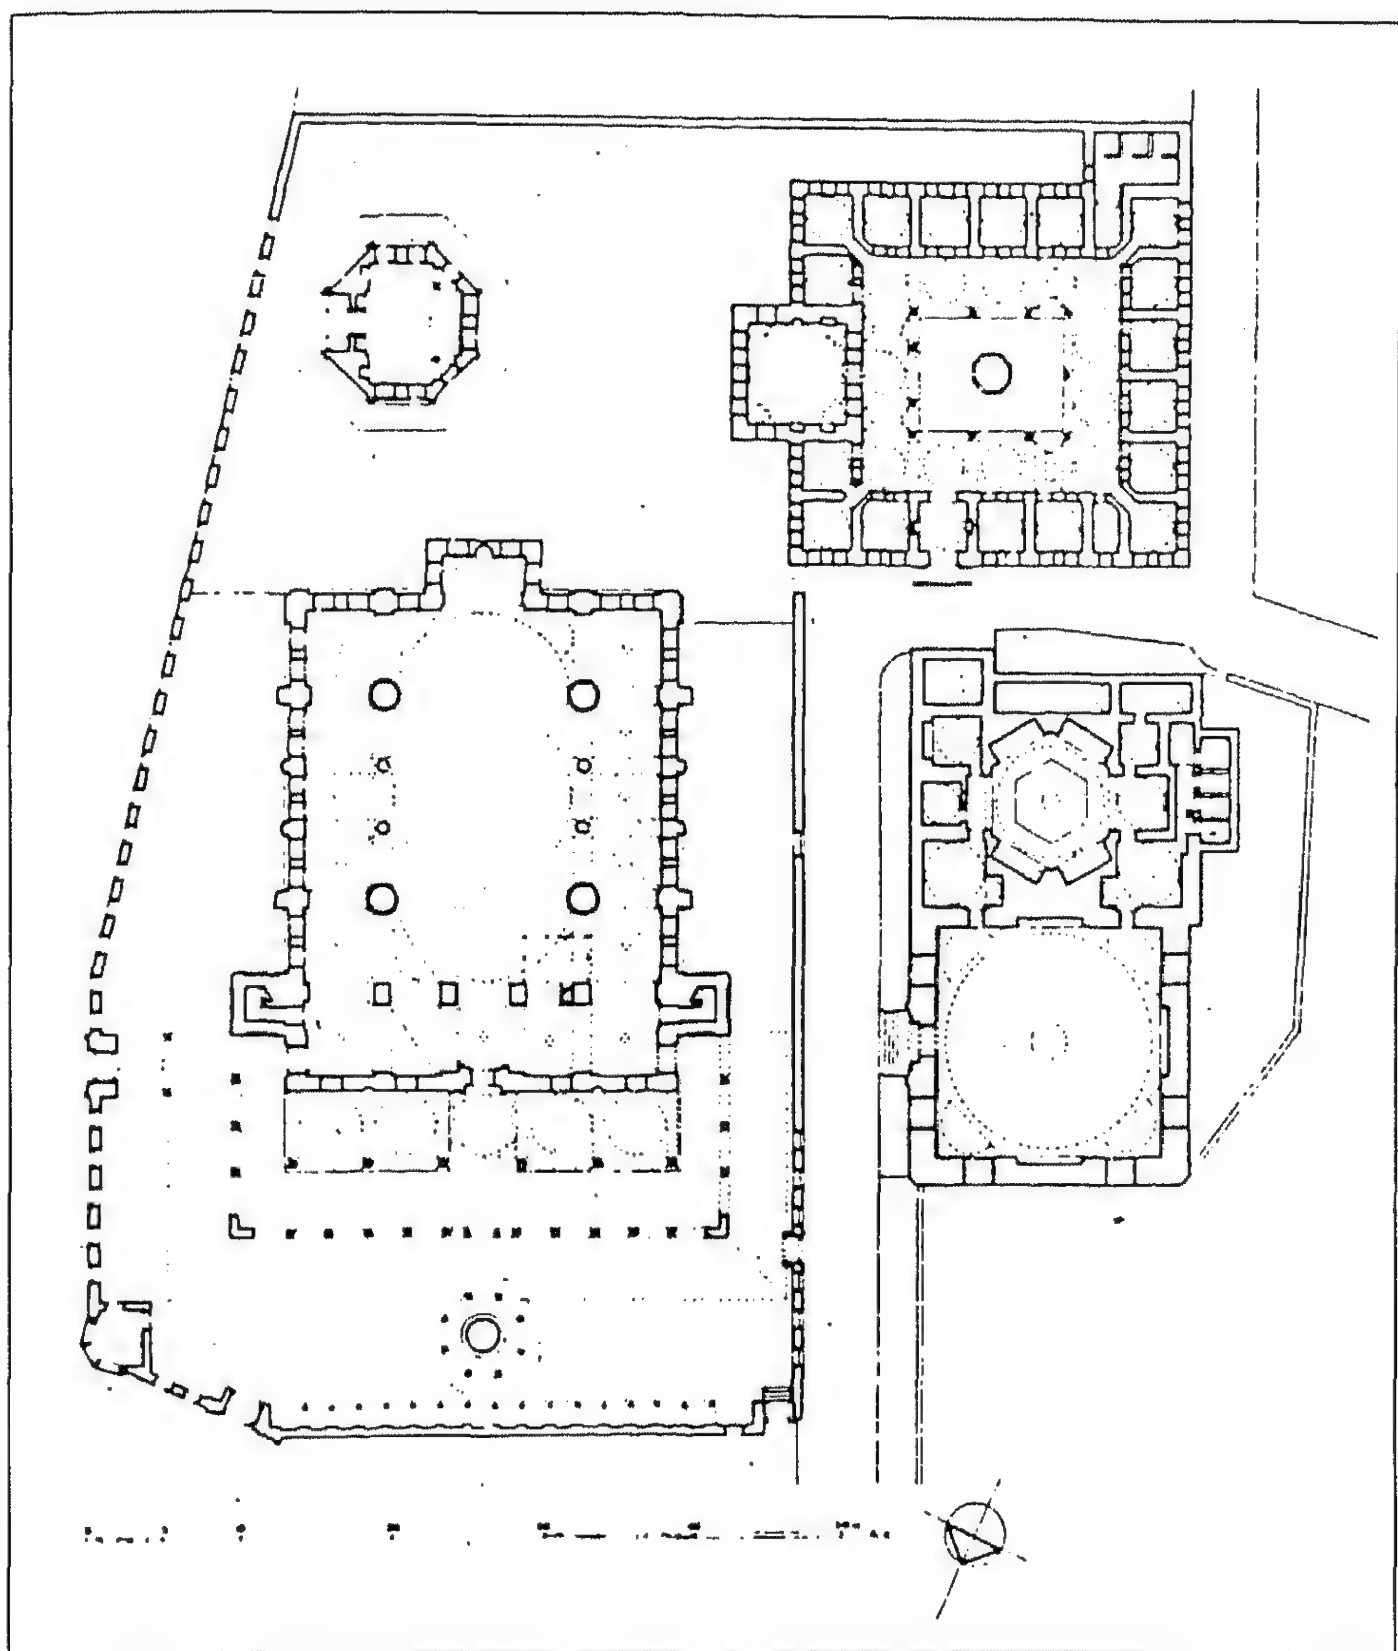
مسقط أفقي لحمام محمود باشا بإستانبول (عن : جودوين) .
